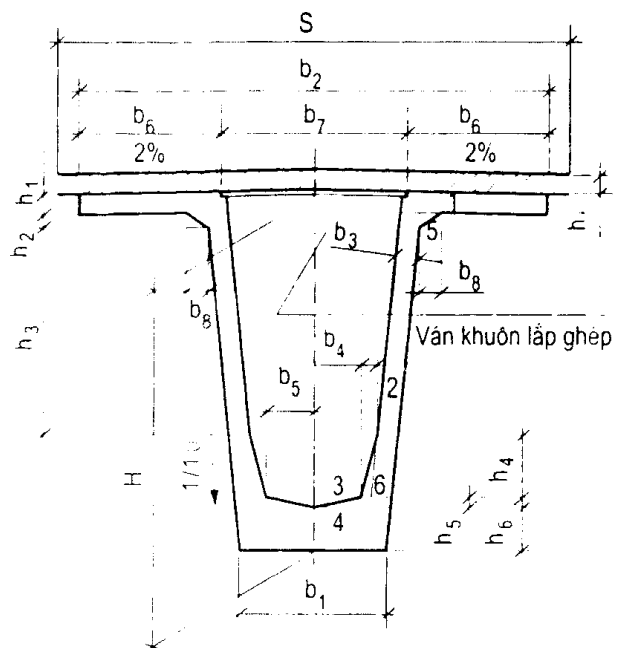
Mặt cắt ngang kết cấu cầu nhịp
